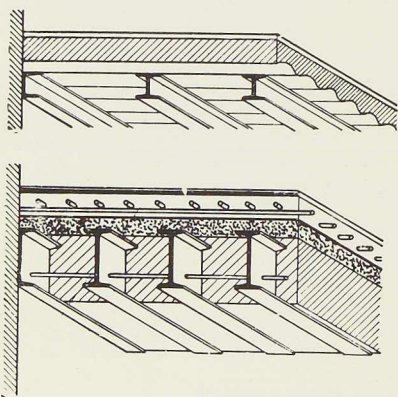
Ciel d'abri en tôles ondulées reposant sur des poutrelles.
